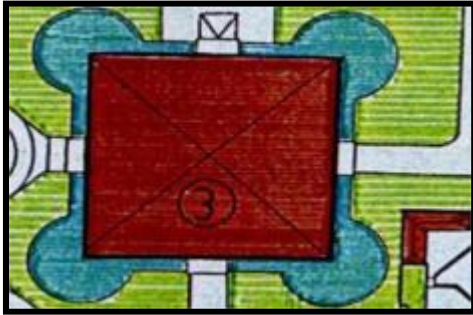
Heykelli Havuzun Yerleşim Planı (ABB, 2009).
